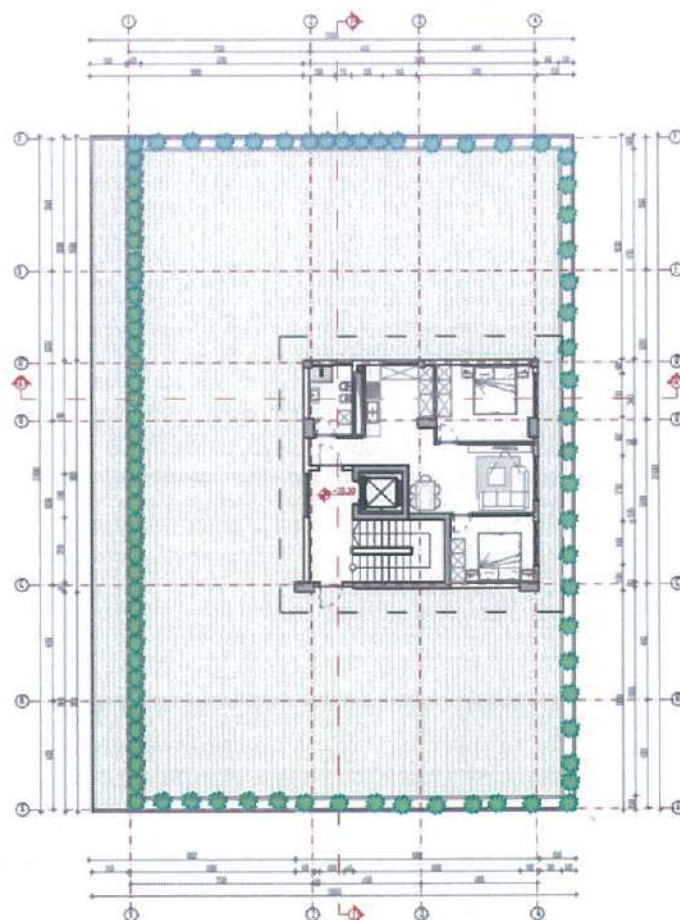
Planimetria e katit të gjashtë, objekti 1 & 2
